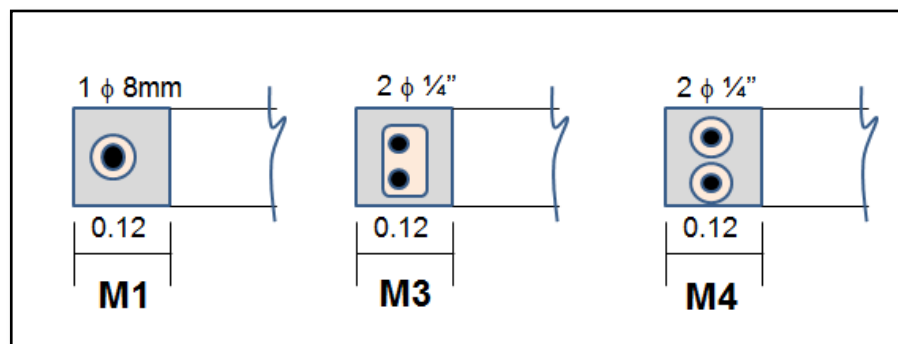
Esquema de distribución de refuerzo en columnas de arriostre.
